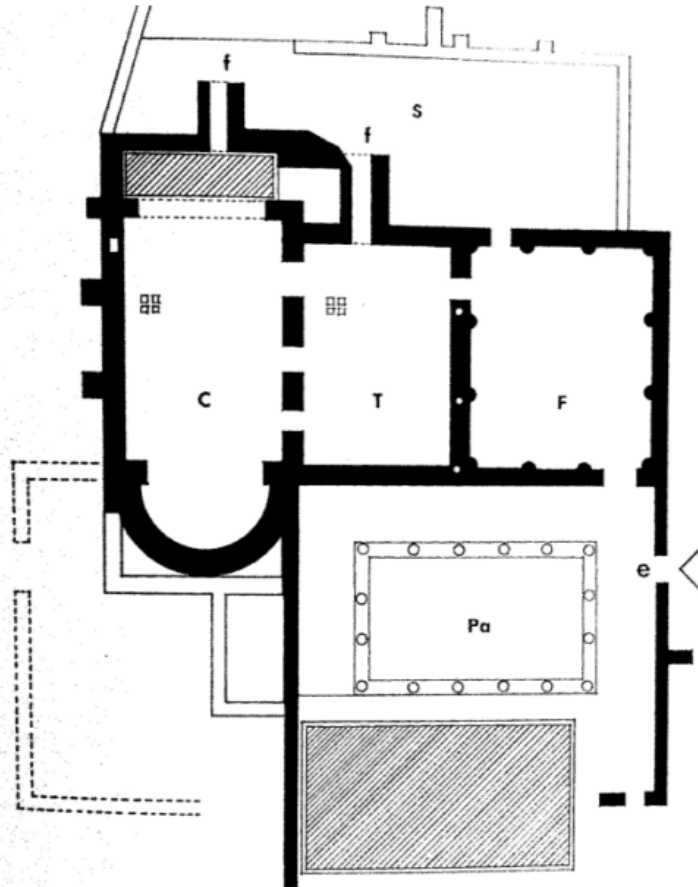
Stabia Hamamı Asimetrik Planı (Yegül, 2006, s. 59 planı altlık olarak kullanılmıştır).
